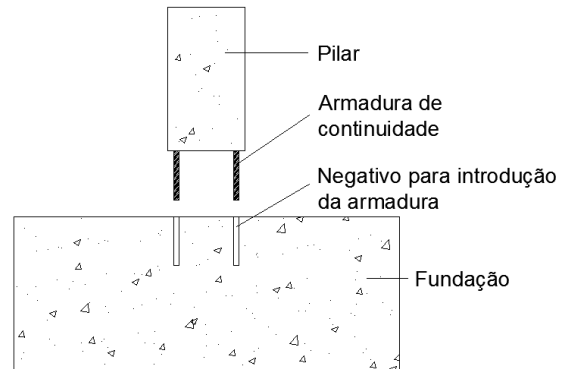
Ligação com armaduras de continuidade salientes do pilar
